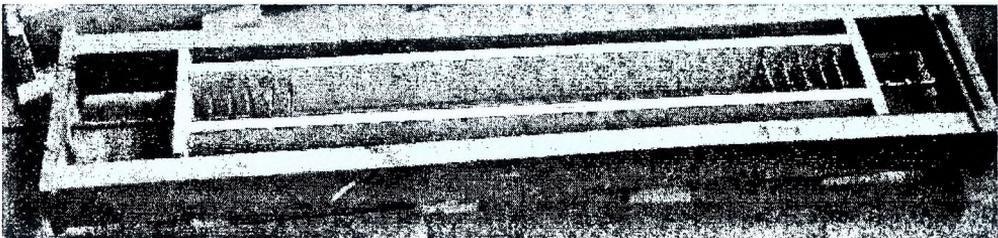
Общий вид опытного образца марки КНК40 перед укладкой напрягающего бетона
